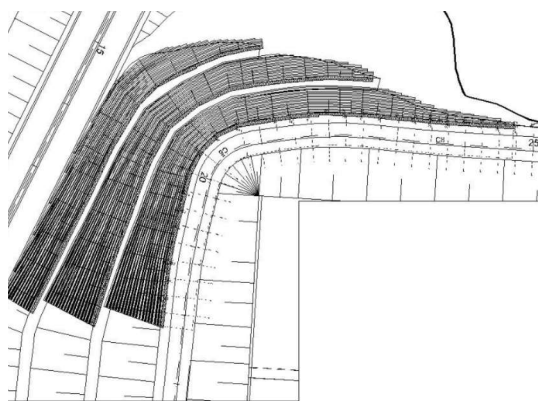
Vista em planta da implantação da ESR com Terramesh® Verde
